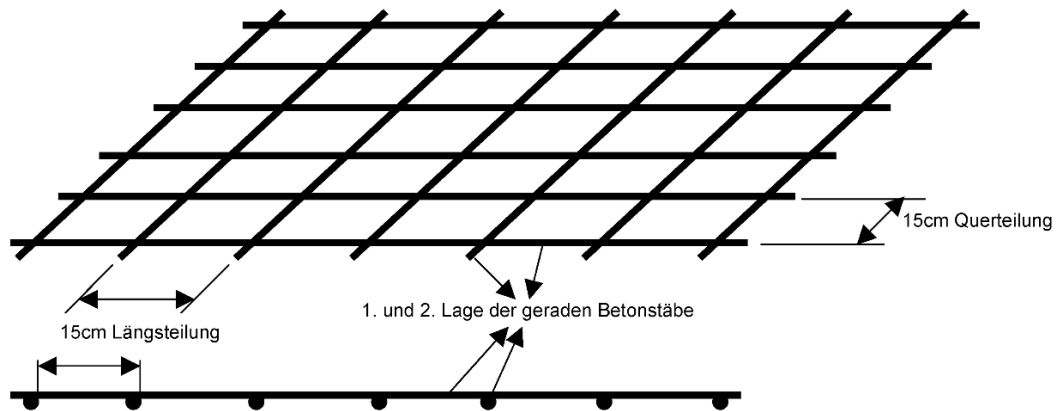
Betonstahlmatte (Ausschnitt) in ihrer Perspektivdarstellung oben und in der Seitenansicht darunter
